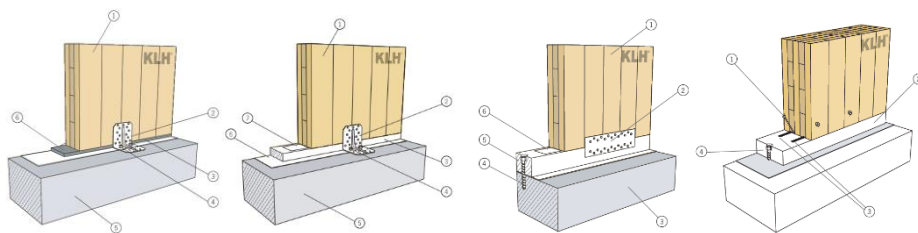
Base das paredes exteriores: a) Sem travessa de base; b) Com uma travessa de base de madeira de reduzida espessura; c) Com uma travessa de base de madeira de maior espessura; d) Painéis de espessuras maiores (KLH Massivholz GmbH, 2013b).
